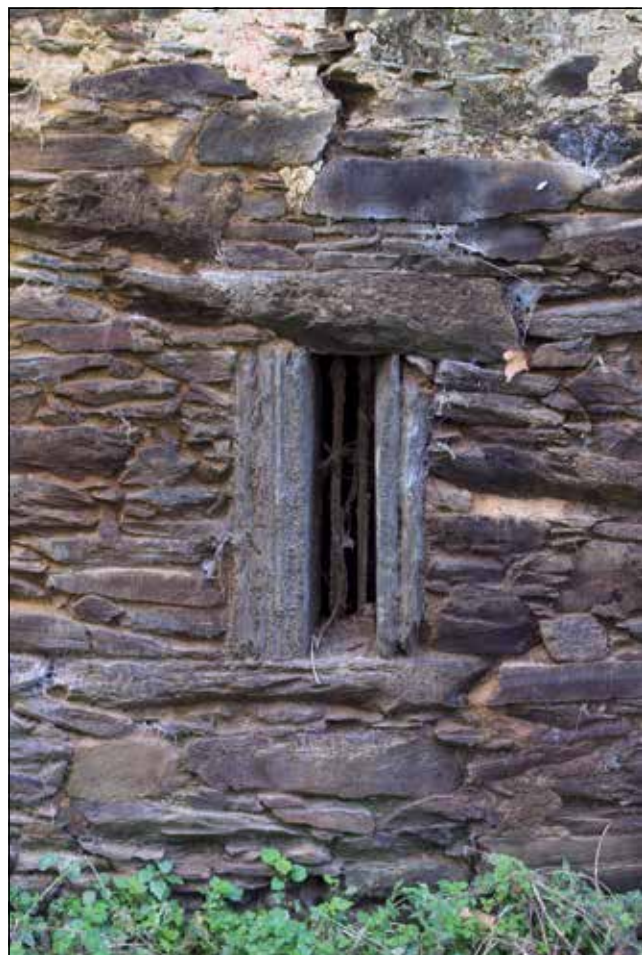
Ventanita de la fachada oeste de la crujía de orientación este-oeste.
